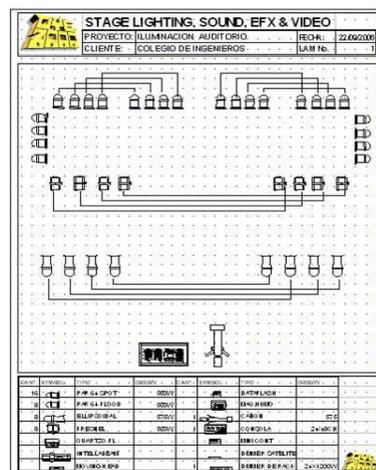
Planta de diseño de Iluminación. Muñoz[23]
